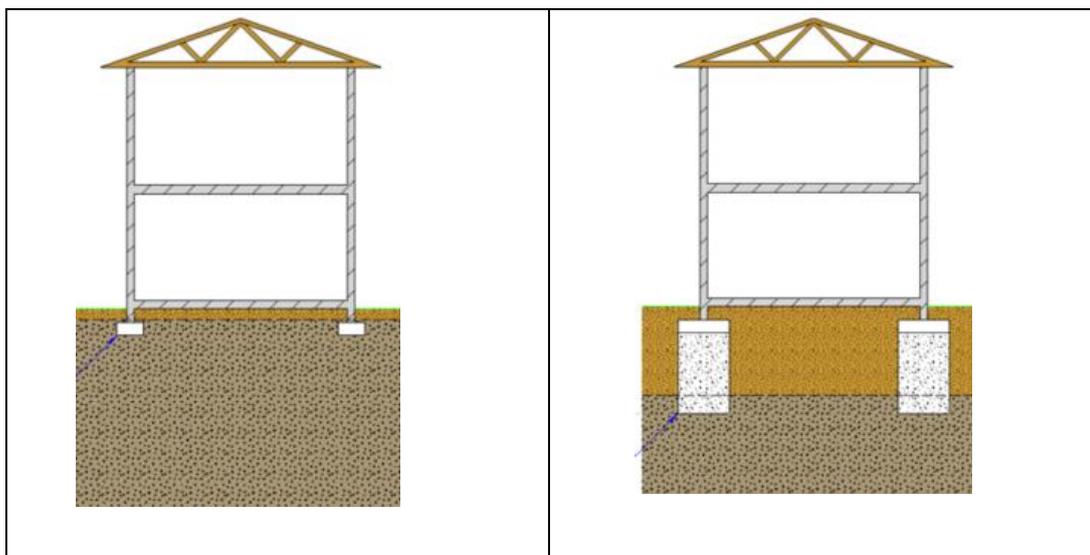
Fondation superficielle et Fondation semi profonde[8]
